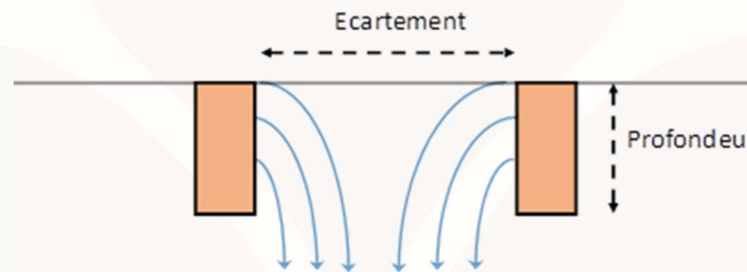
Infiltration à travers les parois latérales d'une tranchée drainante
